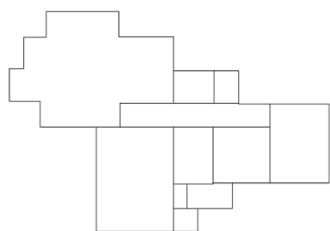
Planta adaptada da original "04-1981/00-2"
